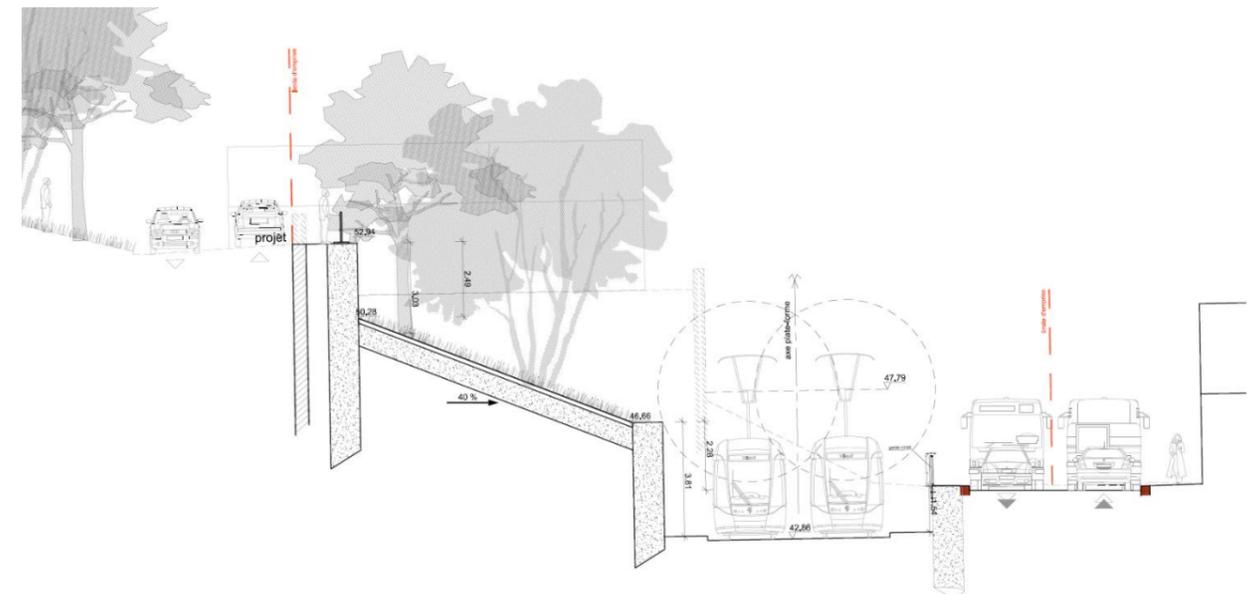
Coupe type au niveau de la tranchée ouverte de sortie du tunnel au droit de la rue Piver
